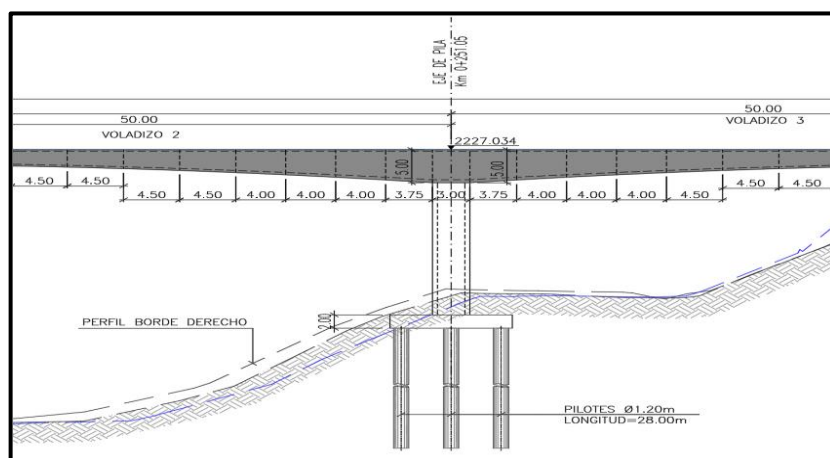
Vista en perfil de la subestructura Apoyo A1.
